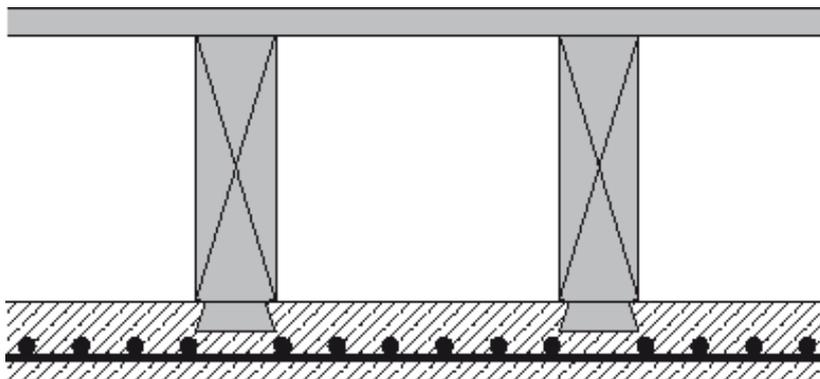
SwissWoodConcreteDeck – Schnitt¹⁴⁷
